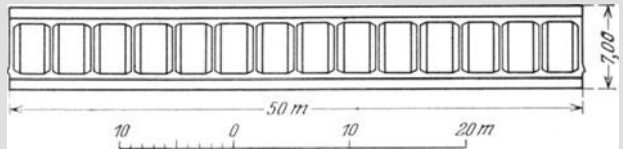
a u. b. Senkkästen, Kopenhagen. Maßstab 1 : 325.
